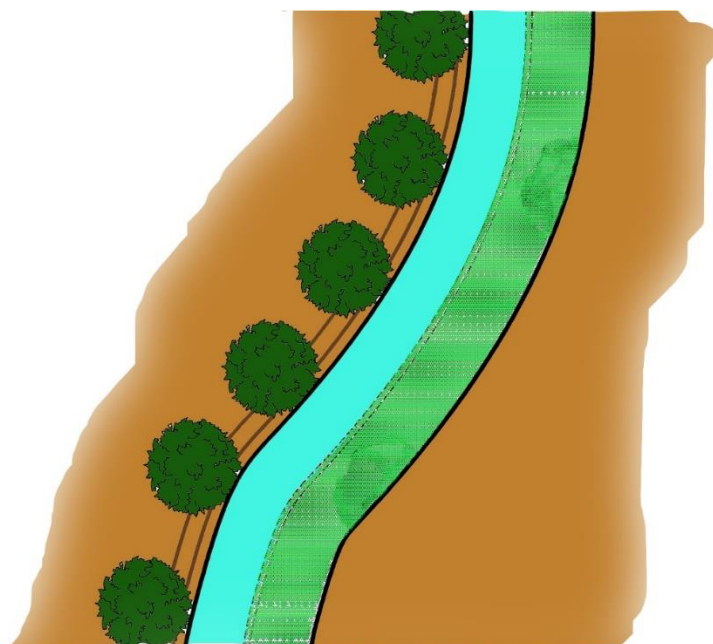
Planimetria ipotesi sezione riprofilata in destra idraulica
